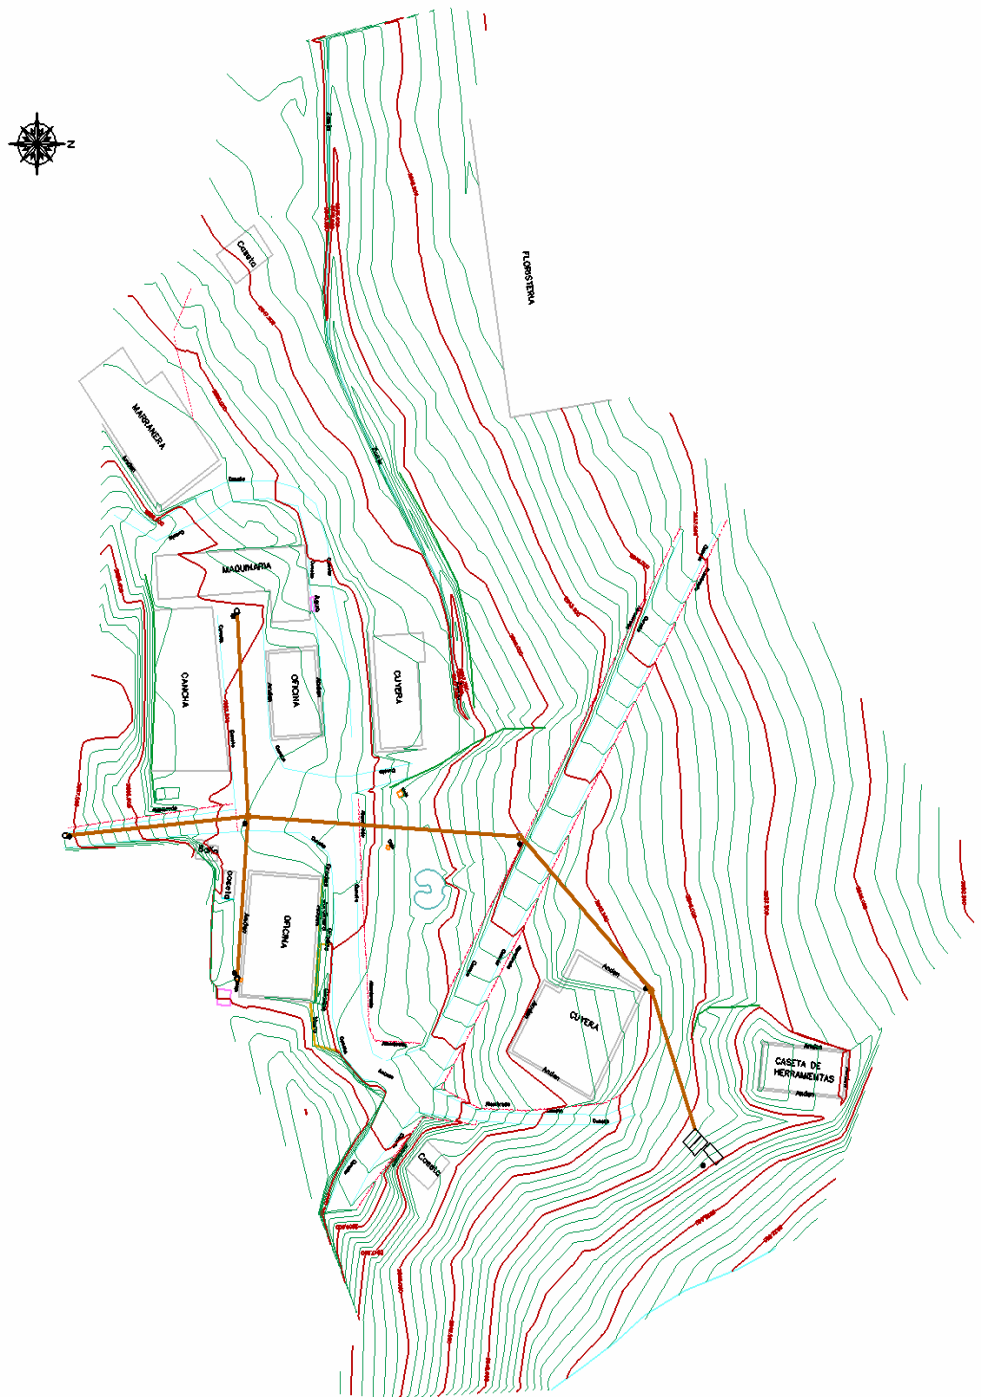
Vista en planta alcantarillado sanitario.(Anexo plano N° 3)
